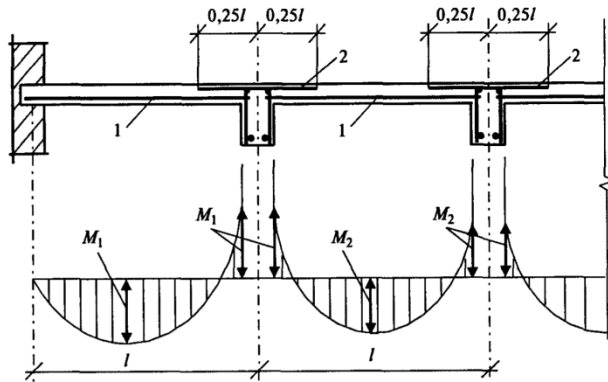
Эпюра моментов и армирование плиты ребристого перекрытия:
